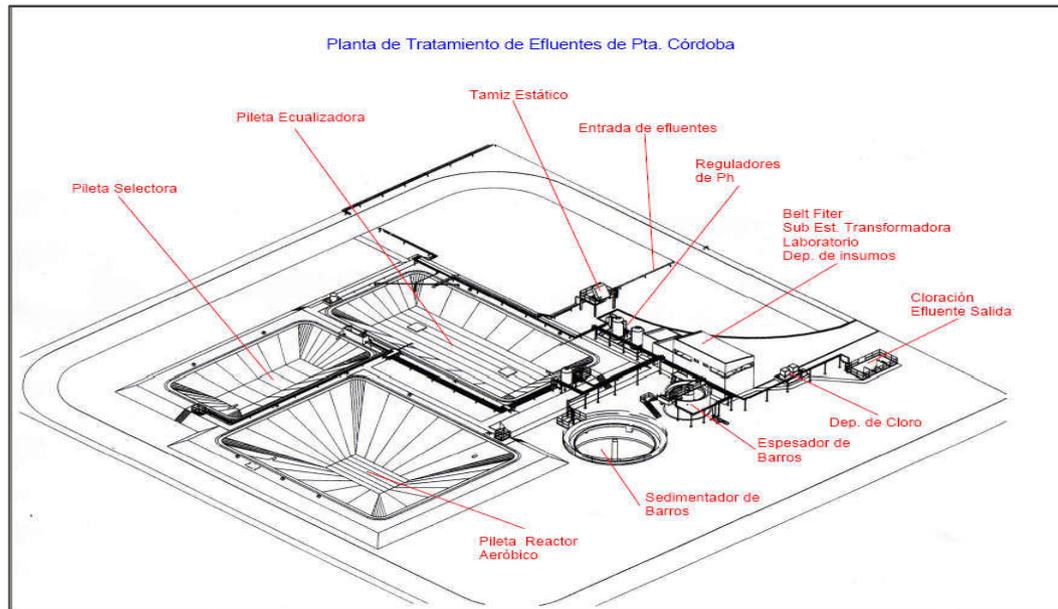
Plano de Planta de Tratamiento de Efluentes
